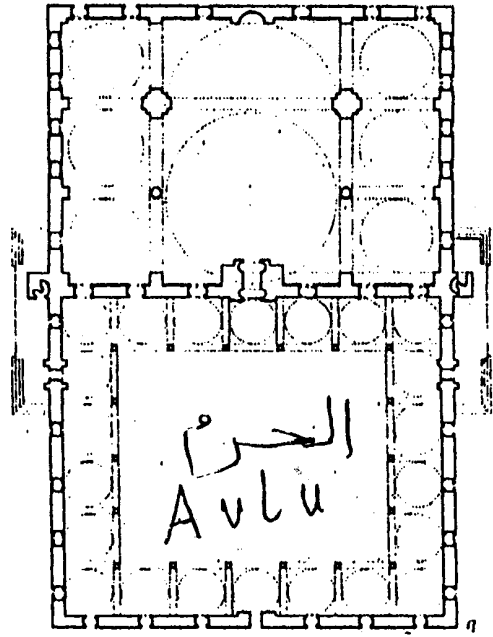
مسقط أفقي لجامع عتيق علي باشا في استانبول (عن : Goodwin)
